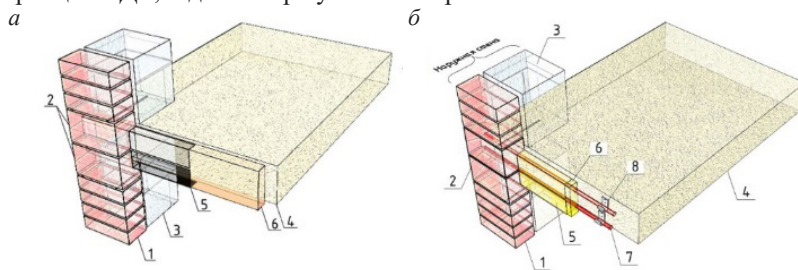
Устройство для утепления наружной стены здания. Вариант 2:
